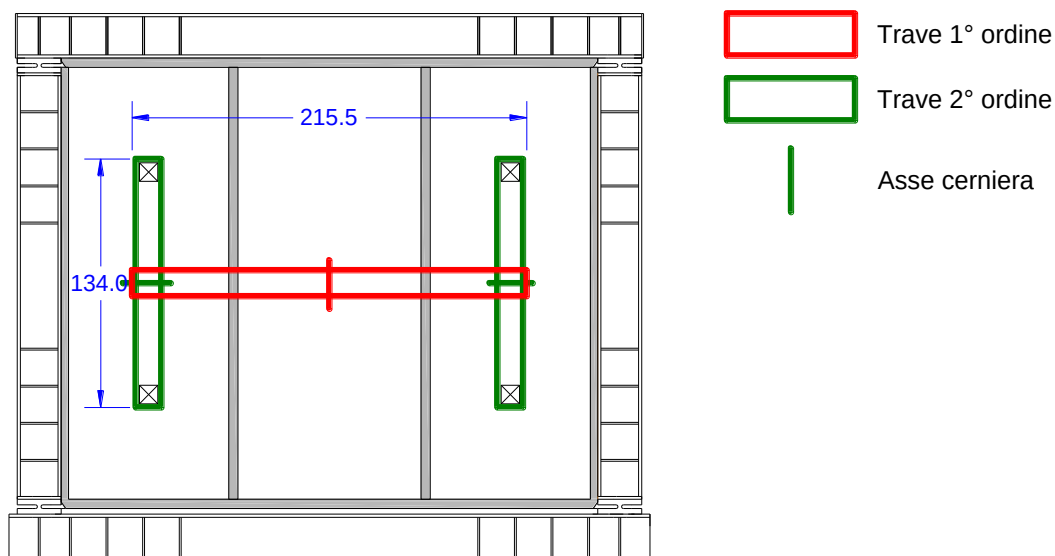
Disposizione delle travi nella prova con giunti e apertura [cm]
